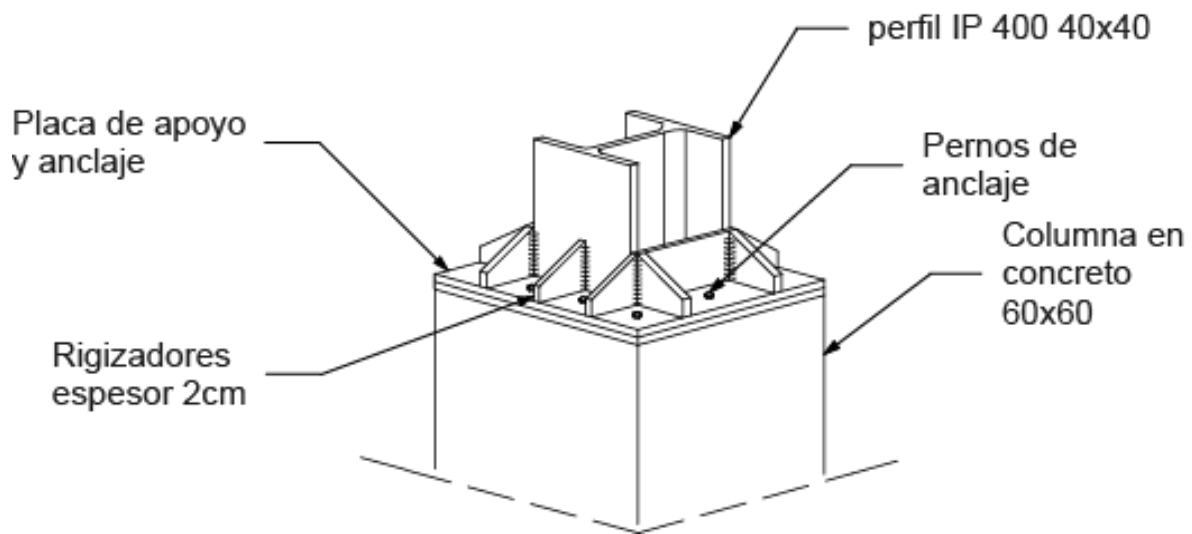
Detalle conexión de columna de concreto con columna en perfil metálico. Vista axonométrica. Fuente: Elaboración Propia.
